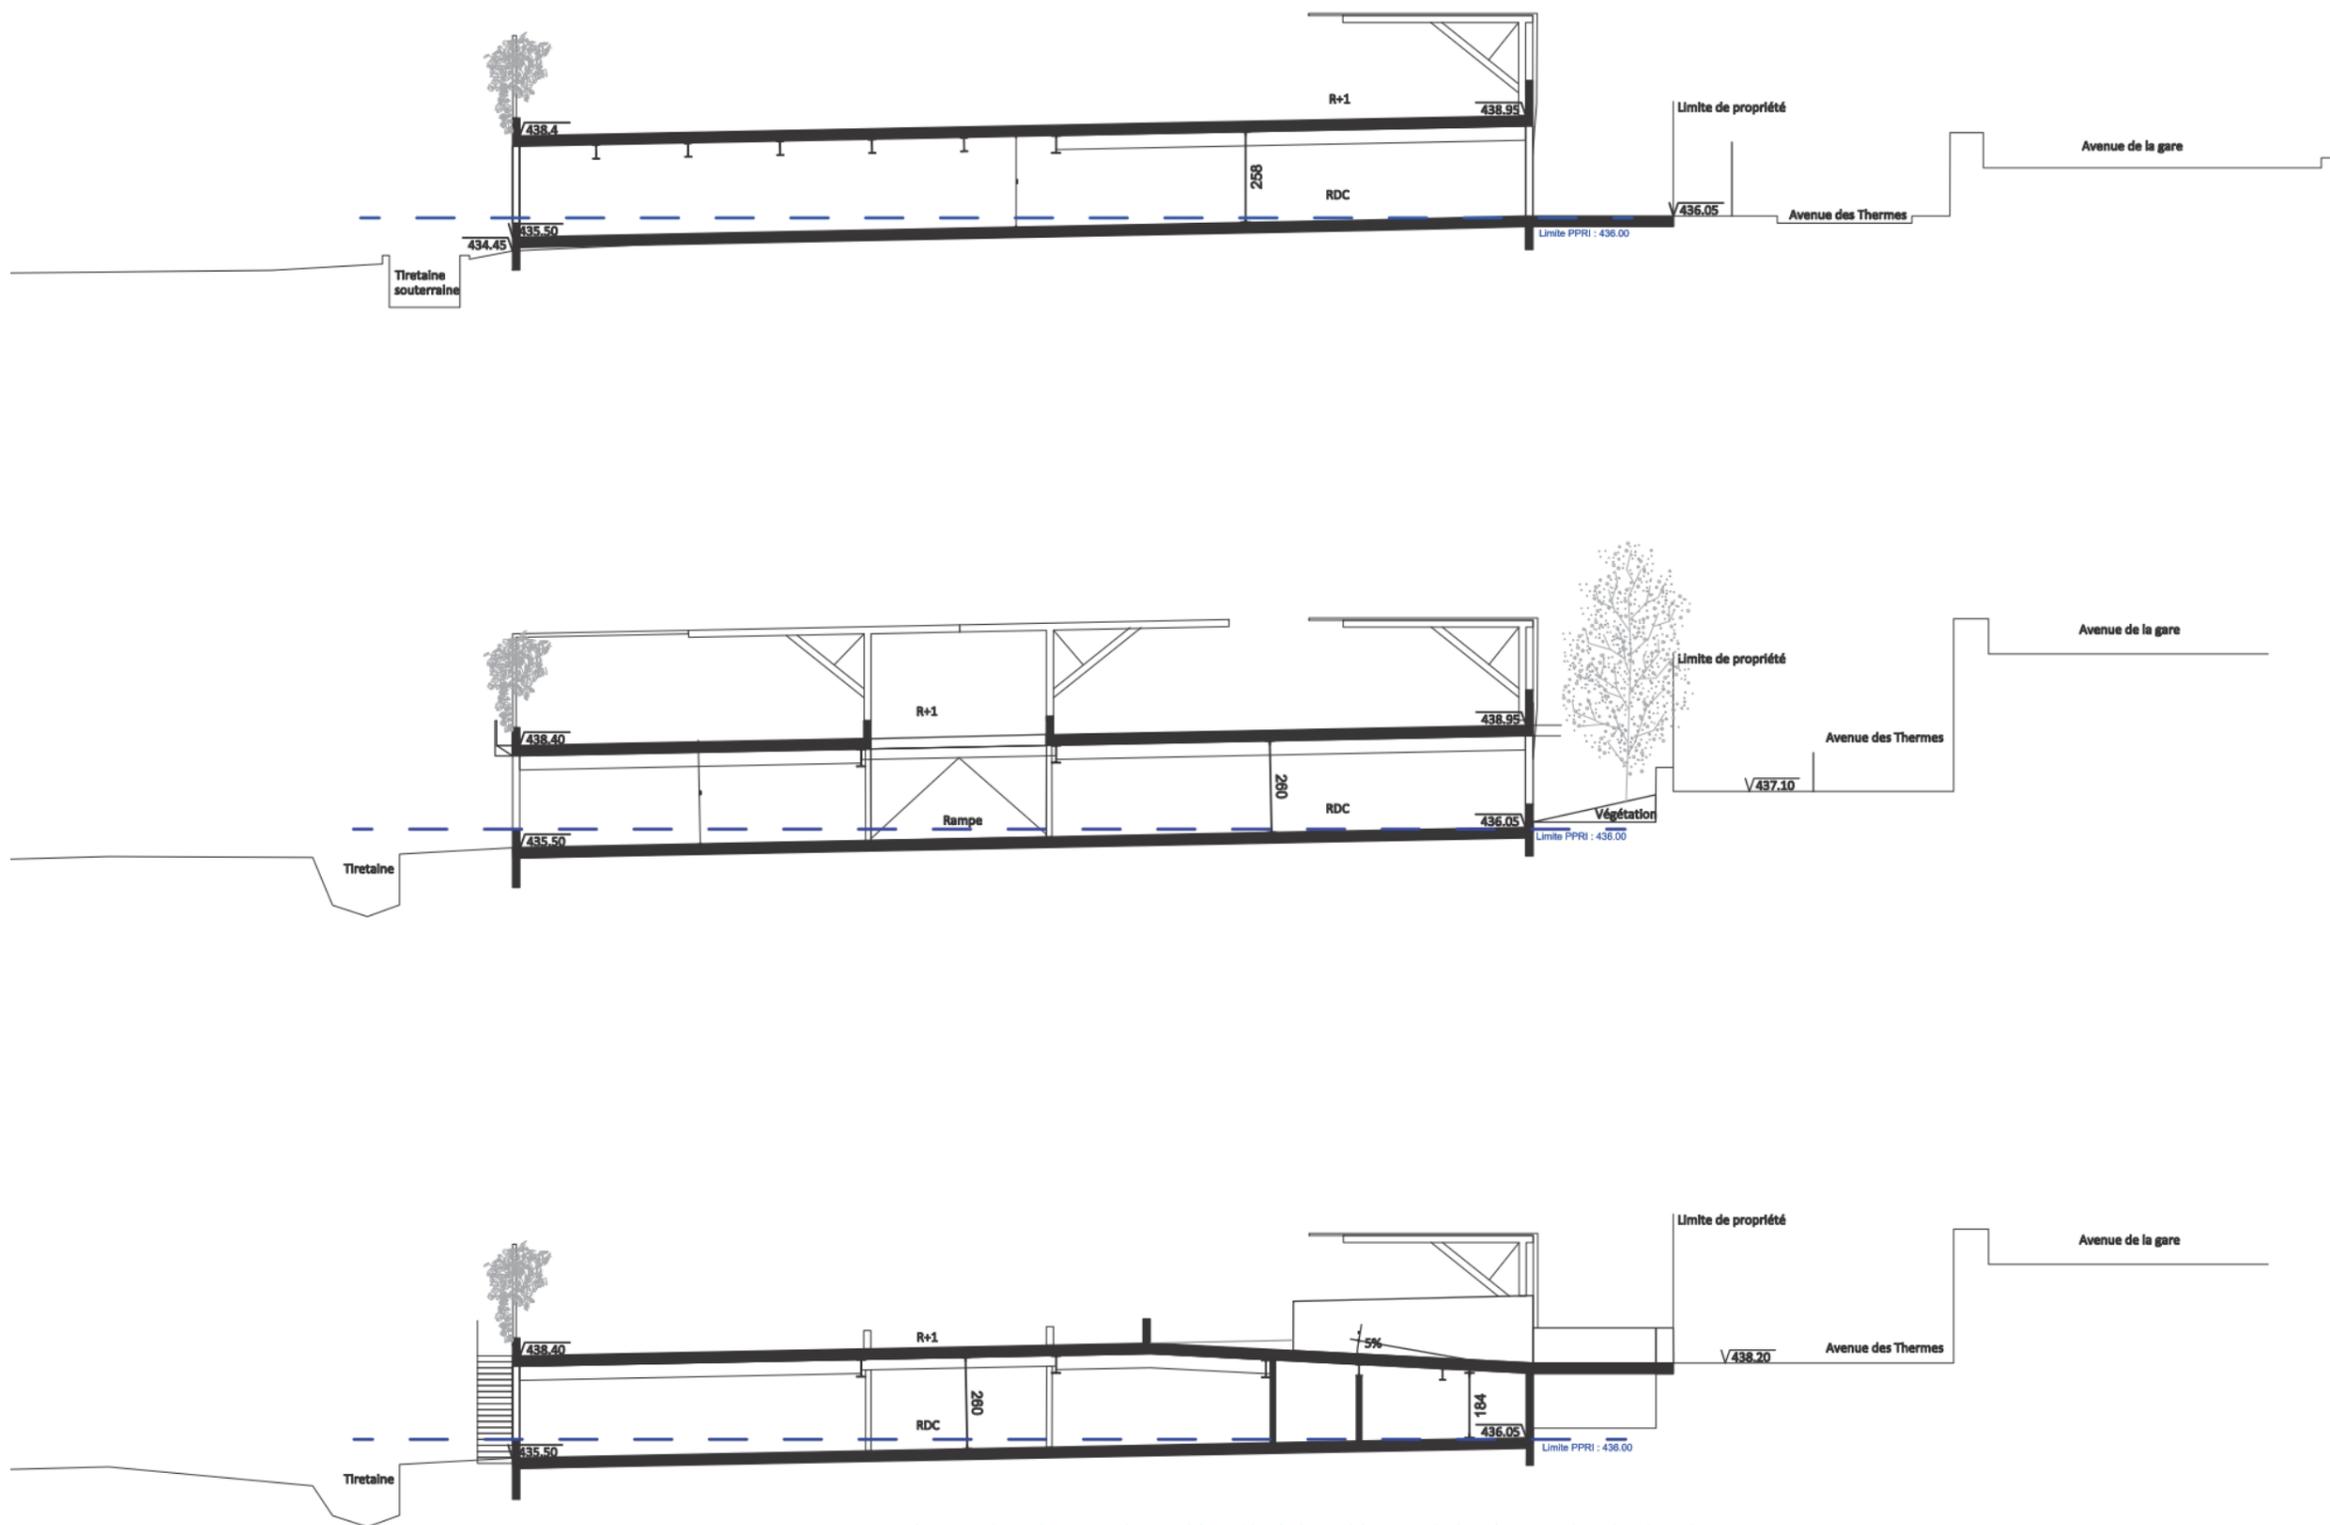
Coupe du parking St Victor et impact du niveau de plus hautes eaux
